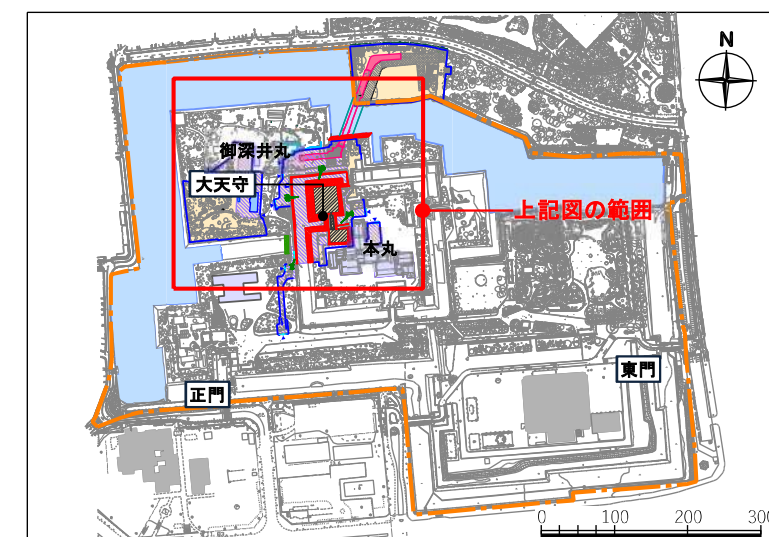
石垣の保存及び安全対策工事時の平面図(敷地全体)
